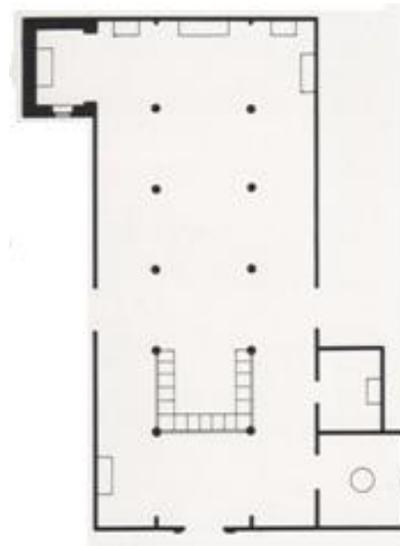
Posible primera planta de la Catedral de Caracas hacia 1661. Paredes perimetrales de bahareque, pilares de madera y el “coro al modo español” entre los cuatro primeros (Duarte y Gasparini, 1989:15).
